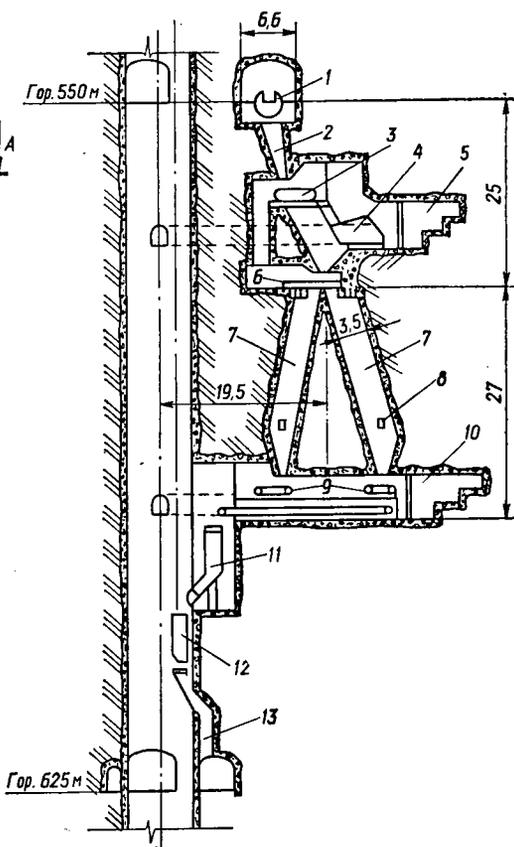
Устройства для загрузки скипов с дробилкой и бункерами:
